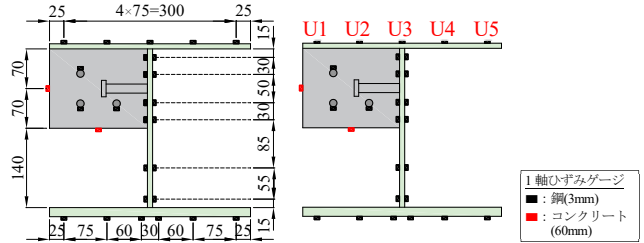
試験体 U9-DC のひずみ計測位置(寸法単位: mm)
